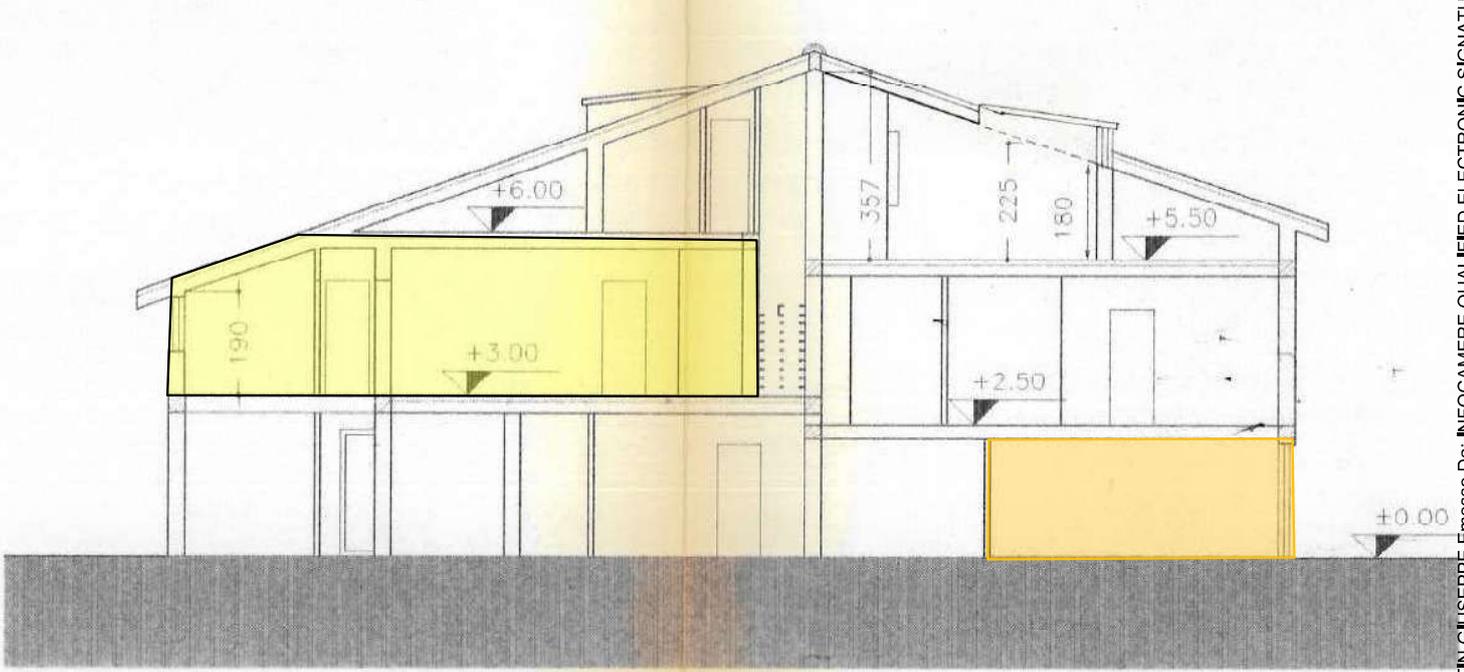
SEZIONE LONGITUDINALE DEL FABBRICATO
